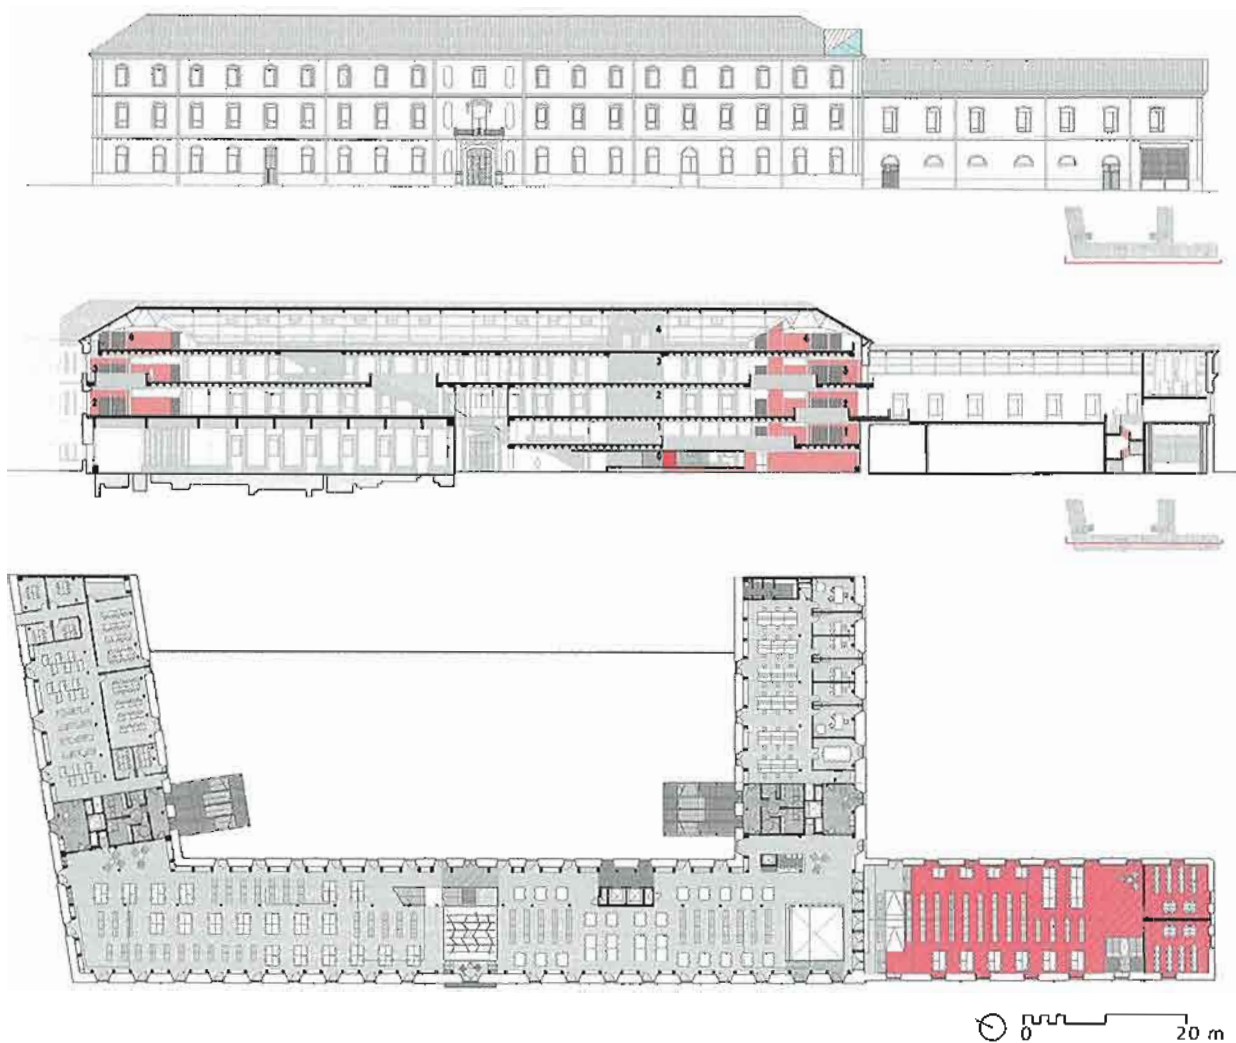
Planta, alzado y sección longitudinal del CRAI. ODE Arquitectura / Figure 5. LCFH plans, section and elevation. ODE Arquitectura
